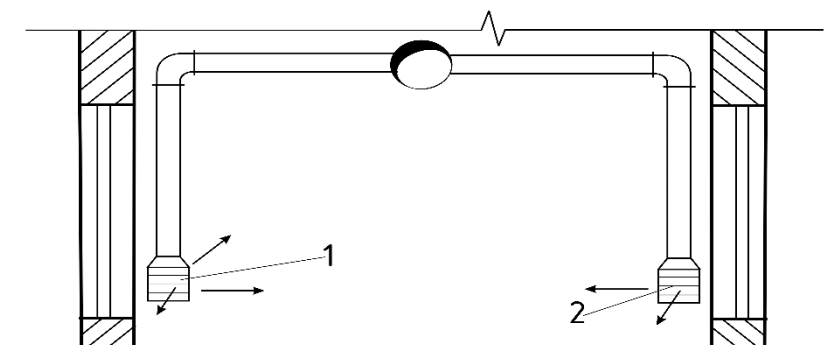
Подача приточного воздуха с помощью насадка 1 с вентиляционными решетками 2
